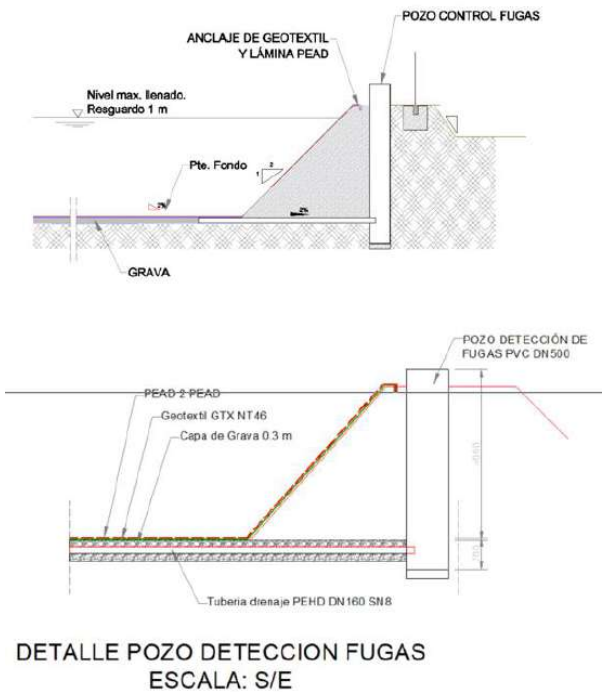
Detalle sistema de detección de fugas + impermeabilización balsa.
